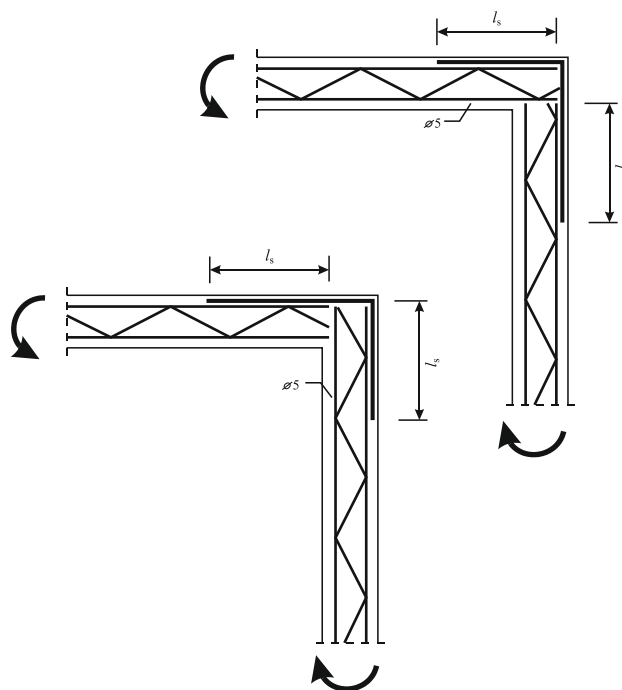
Горизонтальное армирование сетками Murfor угловых зон каменных зданий при действии положительного изгибающего момента [34,35,36]
